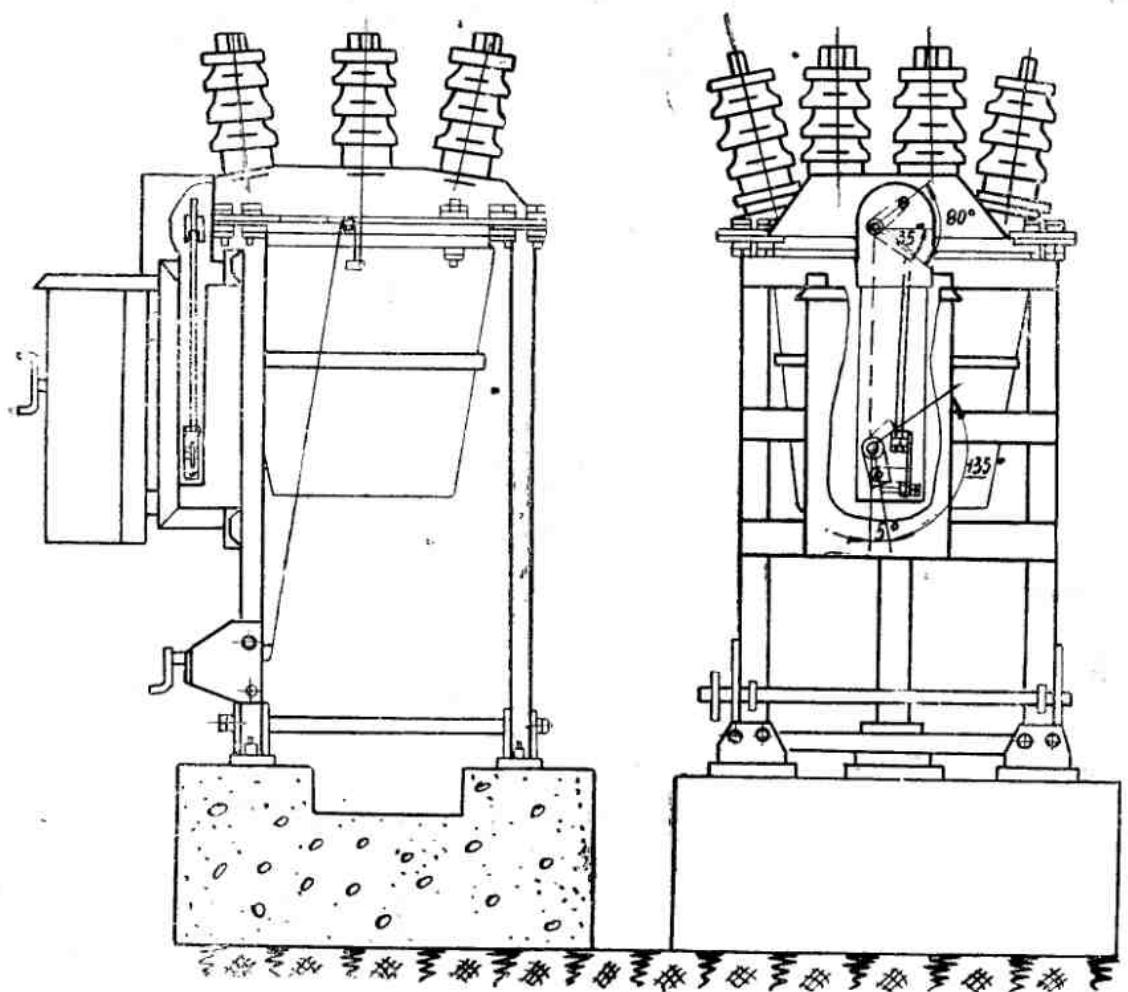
Установка привода типа ПП-87к с выключателем типа ЕМП-10К (ВМП-10) (затяжка винта привода ниже зазора выключателя).
